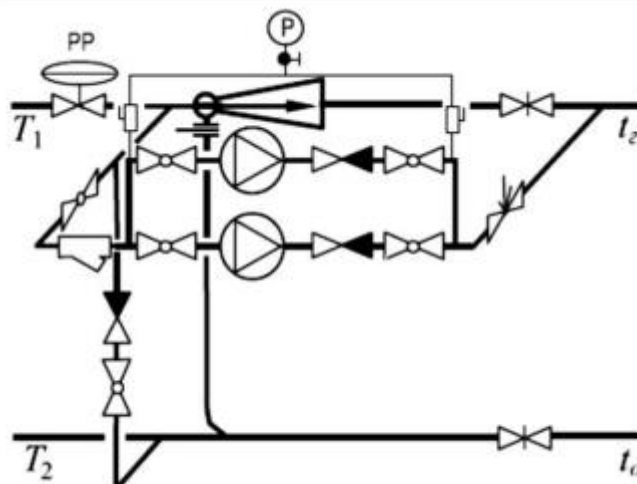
Параллельное гидроэлеватору размещение насосного узла
